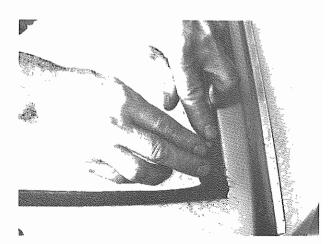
Spianare il sigillante con la spatola Flattening the sealing using the proper spatula
